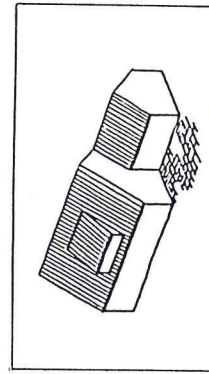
Nebengebäude als Verlängerung des Hauptgebäudes mit niedrigerem Satteldach
